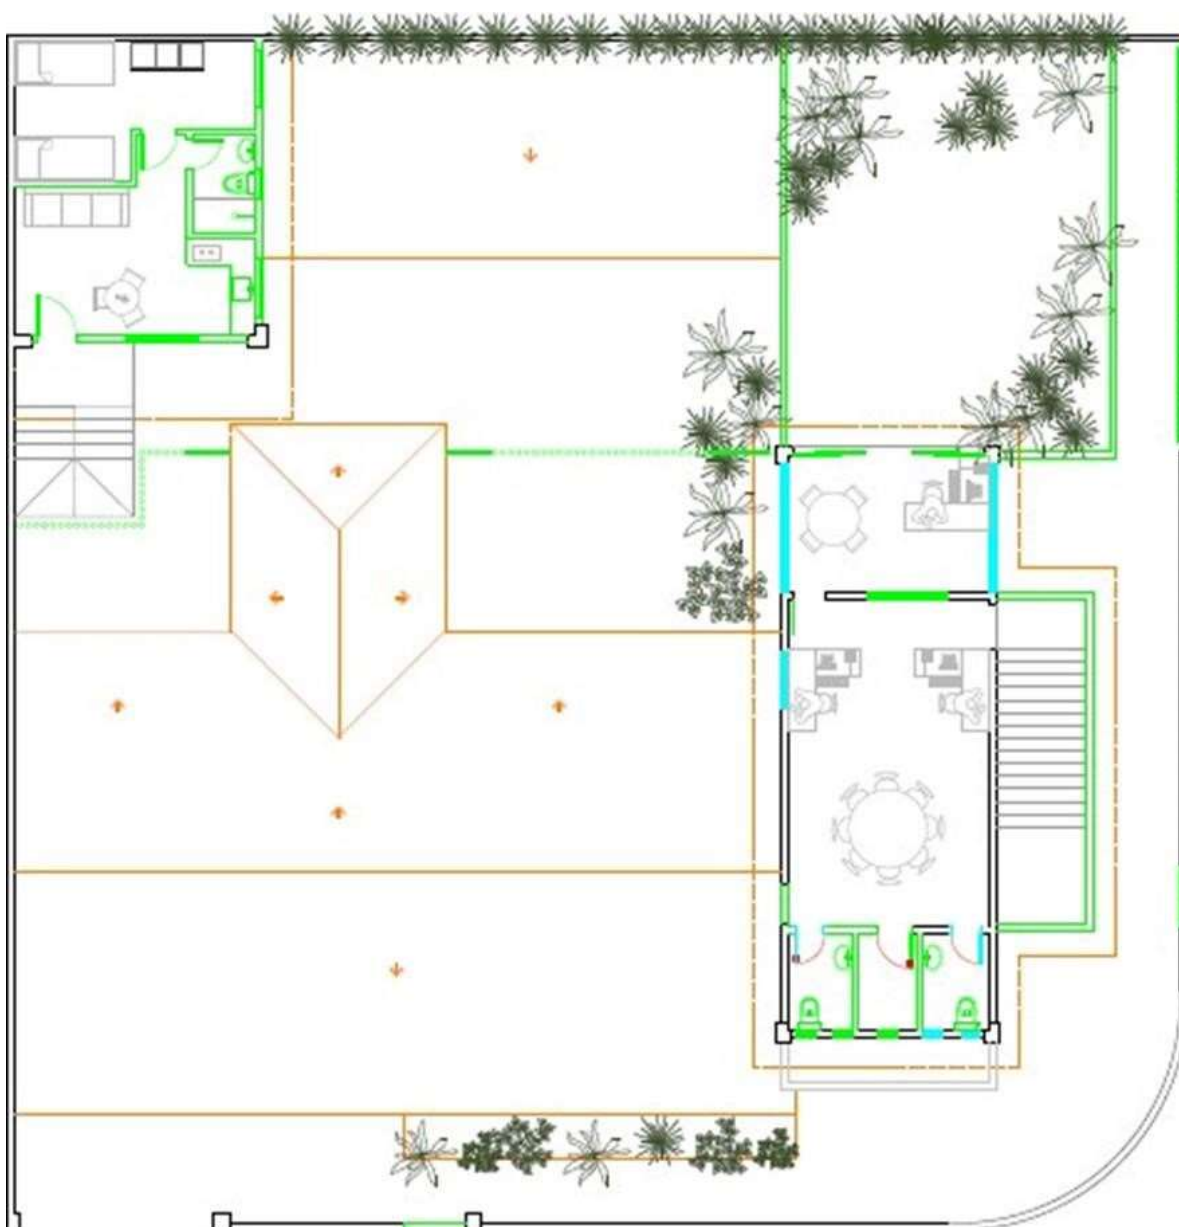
proposta de planta-baixa, humanizada, para o pavimento superior.
